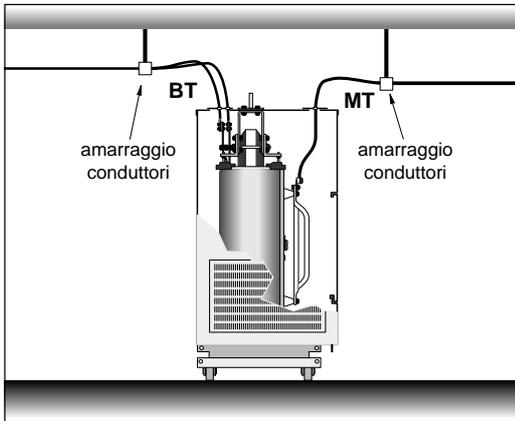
collegamenti MT e BT provenienti dall'alto.
